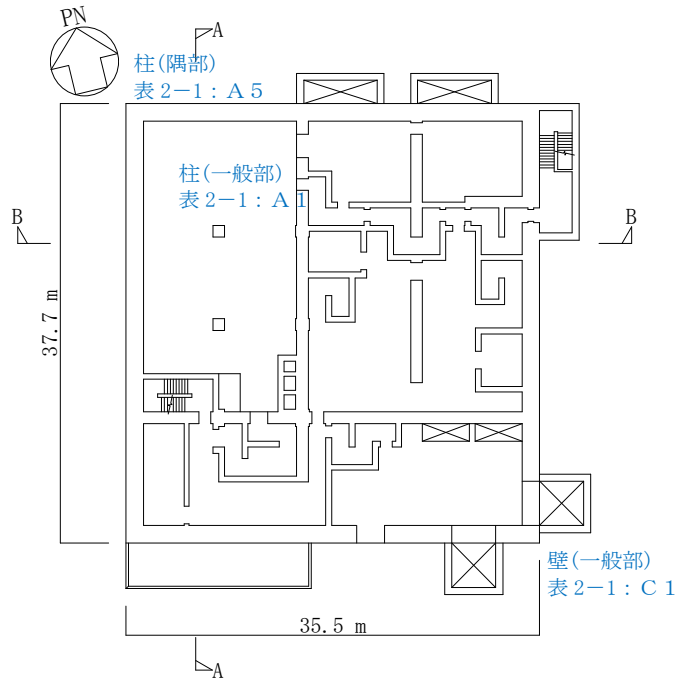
緊急時対策所建屋の概略平面図 (EL. 30.3 m)
